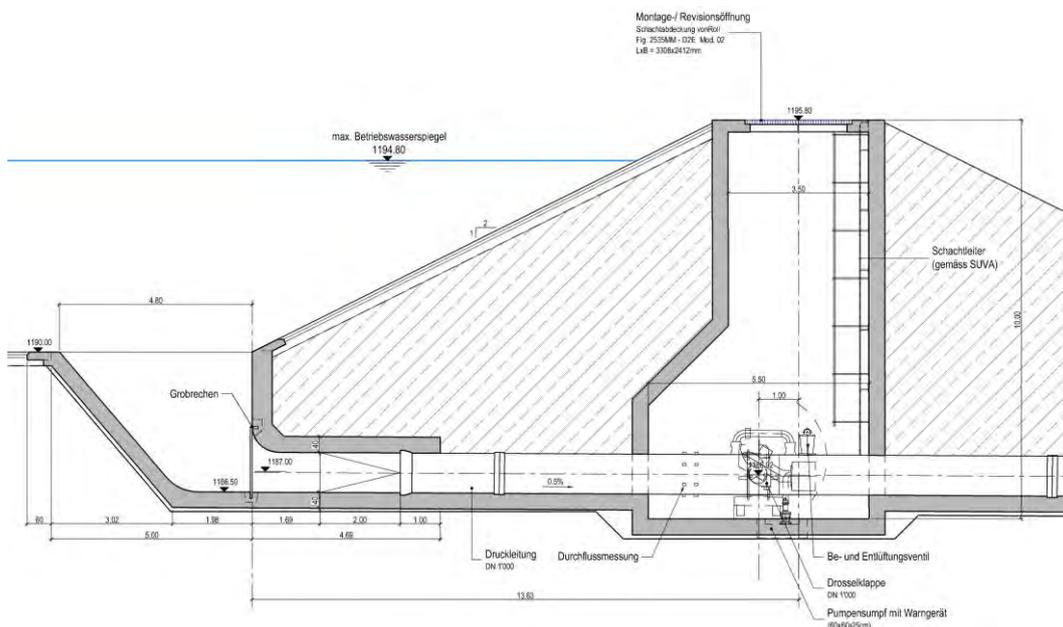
Schnitt durch das geplante Fassungsbauwerk.
